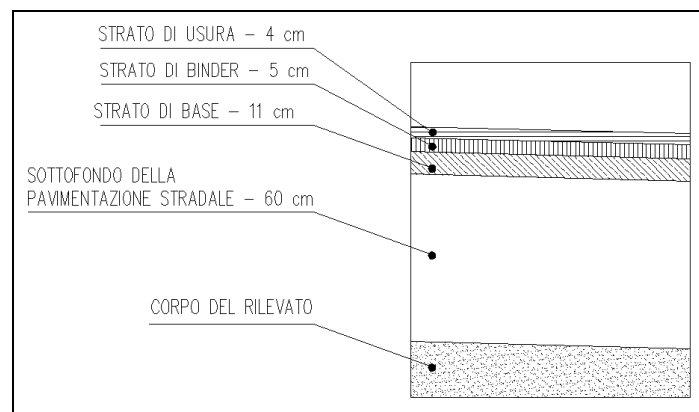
PARTICOLARE PACCHETTO STRADALE
